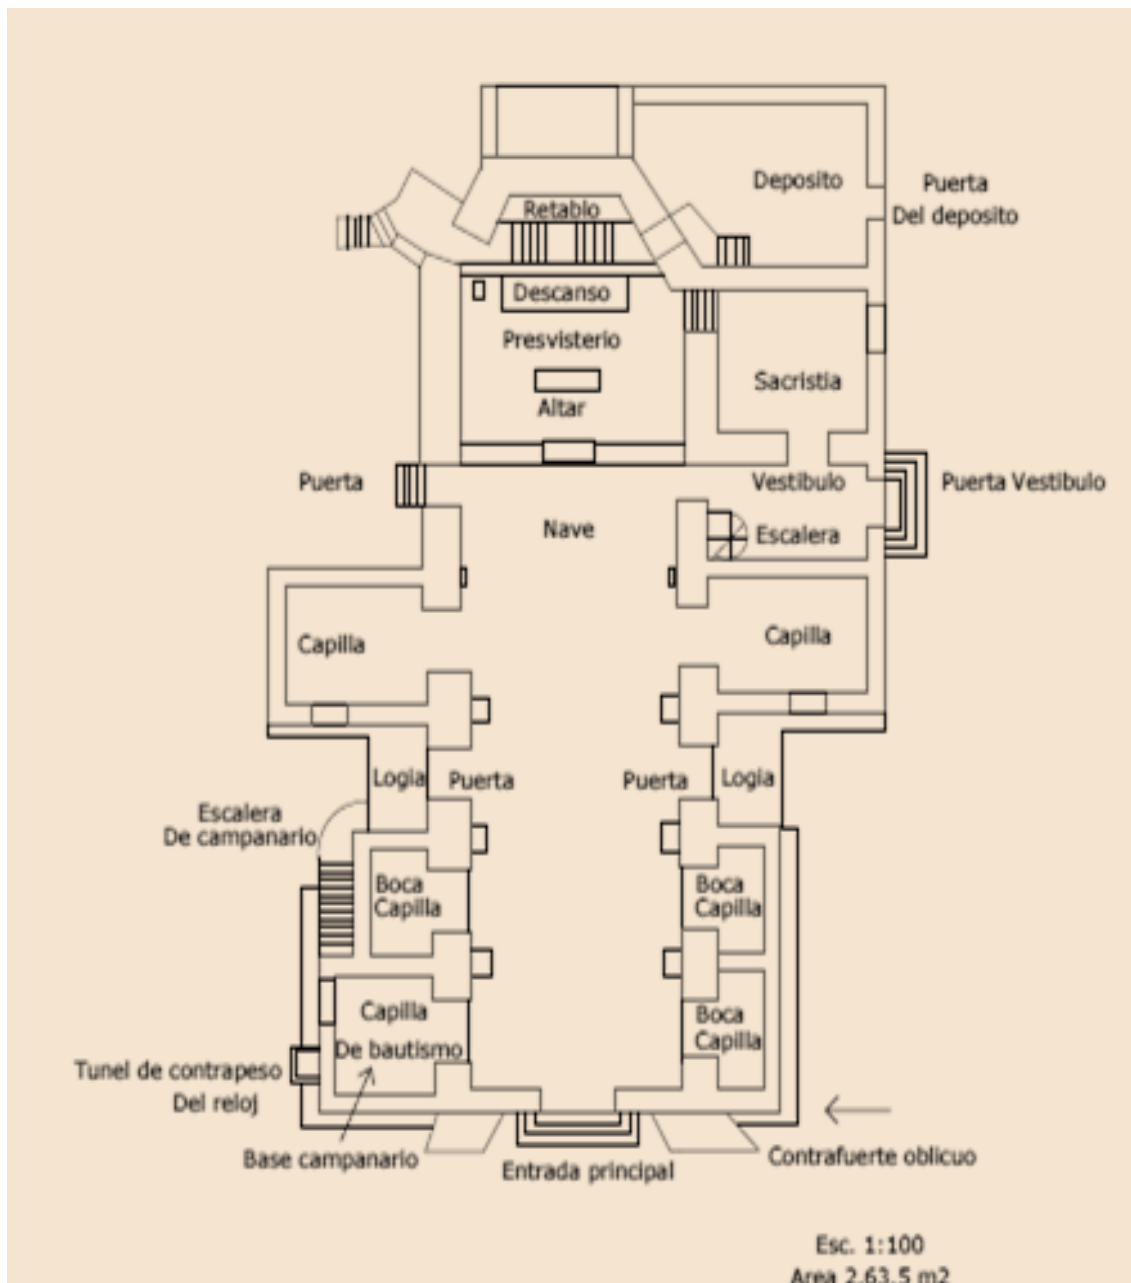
Levantamiento grafico de planta arquitectónica de la composición final de la Iglesia. Fuente: Jemmy Bello (2014)
